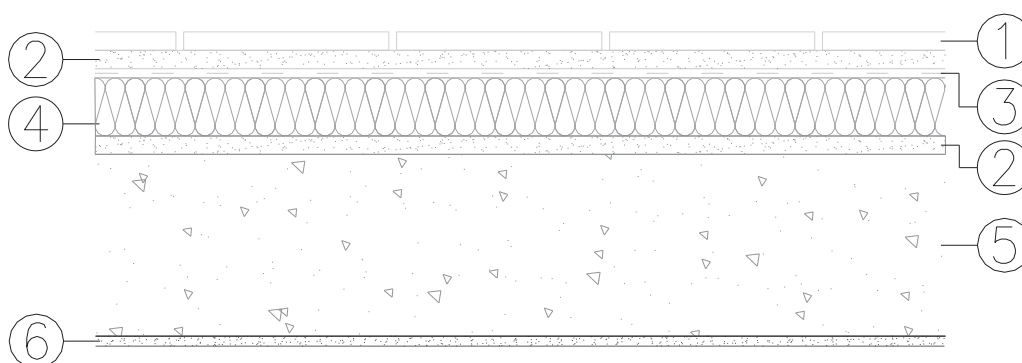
Pavimento Interior (Cozinha e Instalações Sanitárias)
